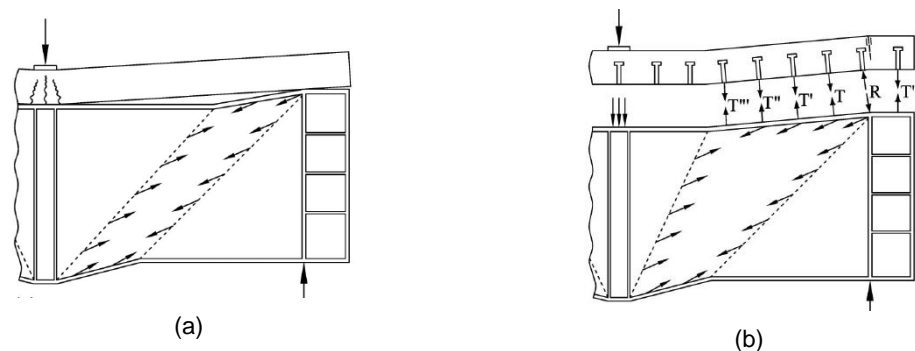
Ação mista aço-betão numa viga de secção composta mista [25]
